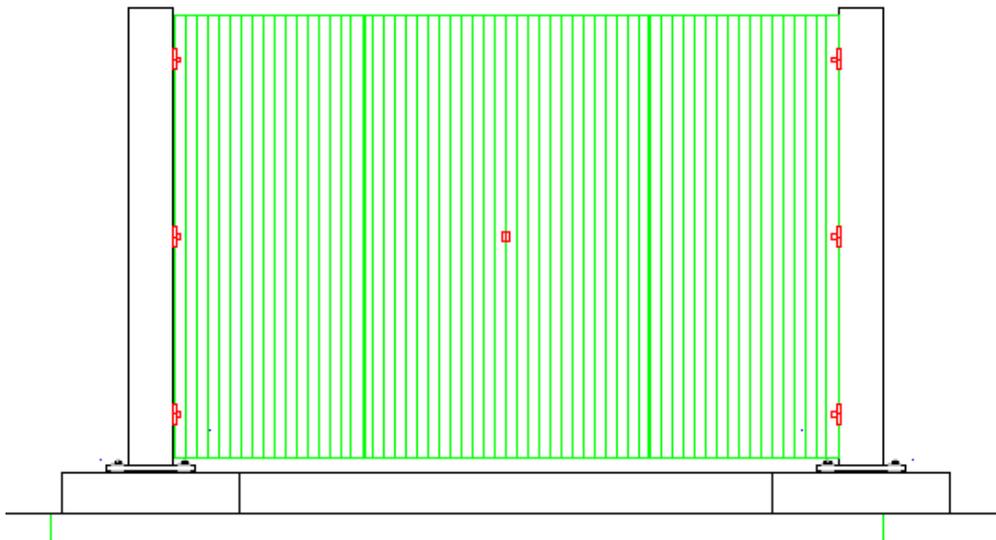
Vista en fachada frontal de la puerta batiente a doble hoja de garaje.
